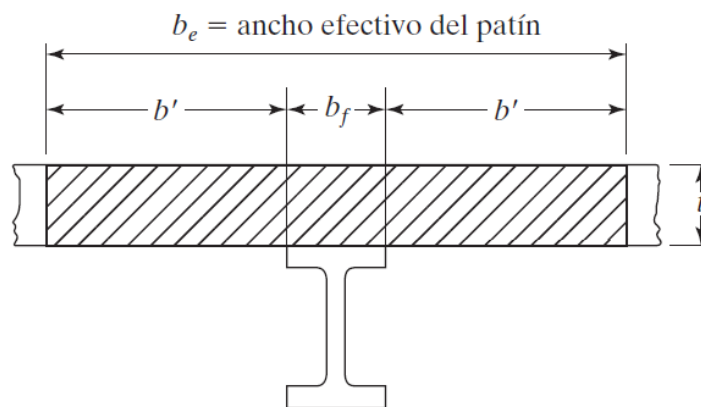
Ancho efectivo colaborante de losa de hormigón (Fuente: Jack C. McCormac 5ª Edición)
